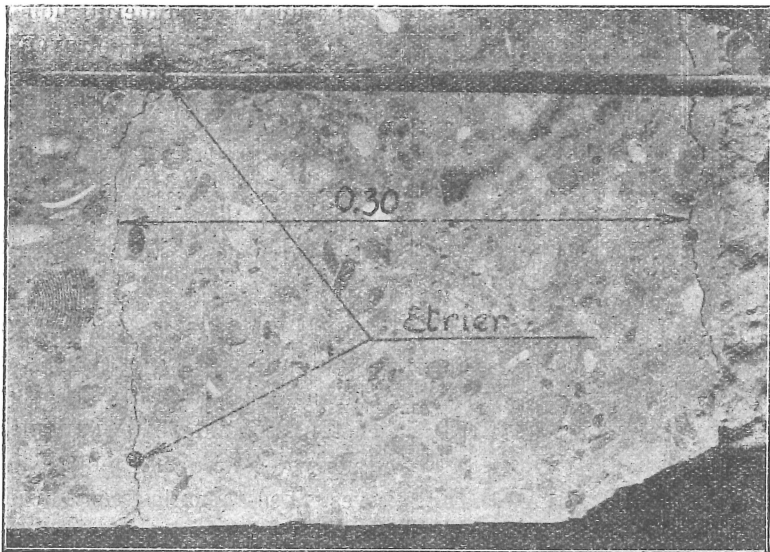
Sciage longitudinal en travers d'un groupe de deux fissures.
